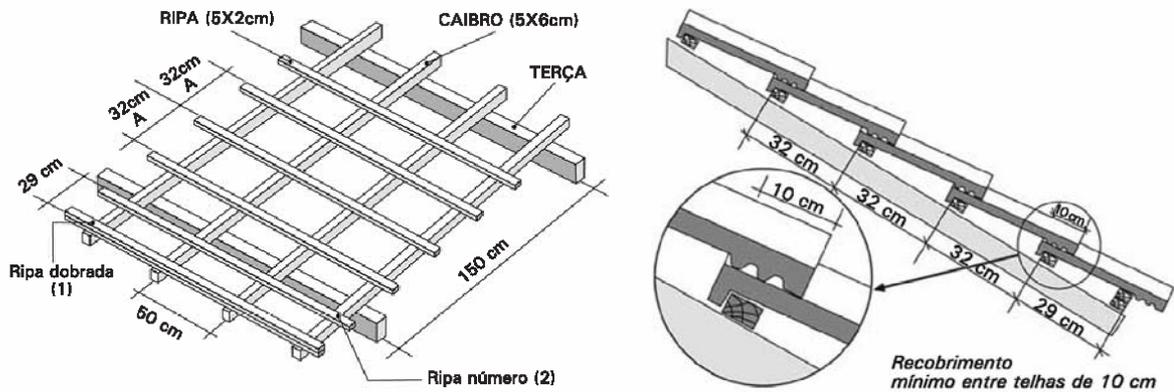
Fixação e encaixe – telhas de concreto. Fonte: TÉGULA, 2006.
